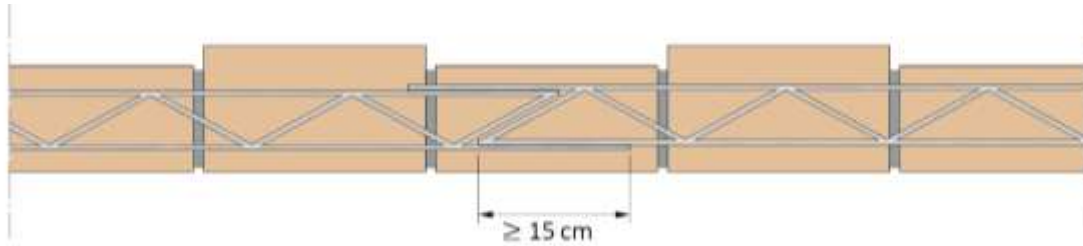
Recouvrement entre sections d'armature – Vue de dessus
